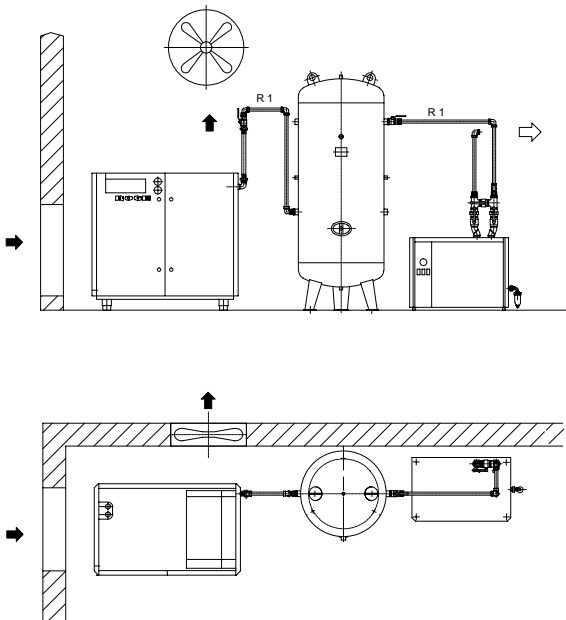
Kompressorstation mit Schraubenkompressor, Kälte-Drucklufttrockner, Druckluftbehälter
